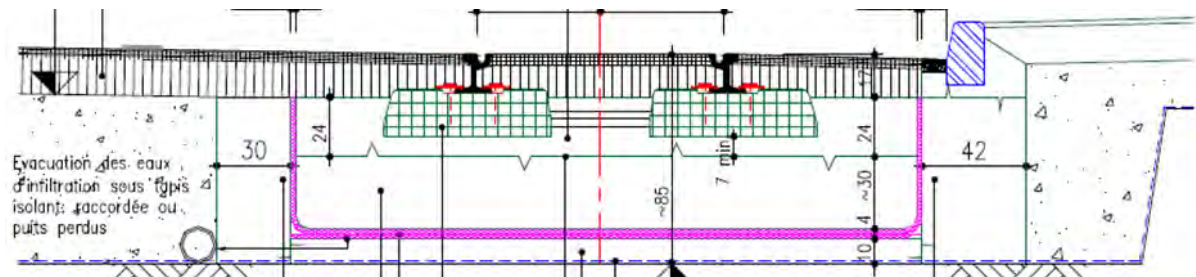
Dalle flottante intermédiaire sur appui surfacique
